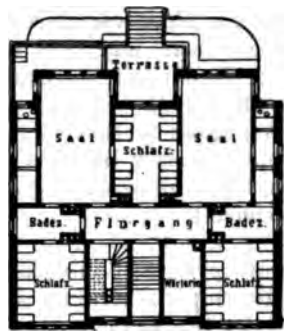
Olga-Krippe von Stuttgart. Grundriß des Erdgeschosses.
